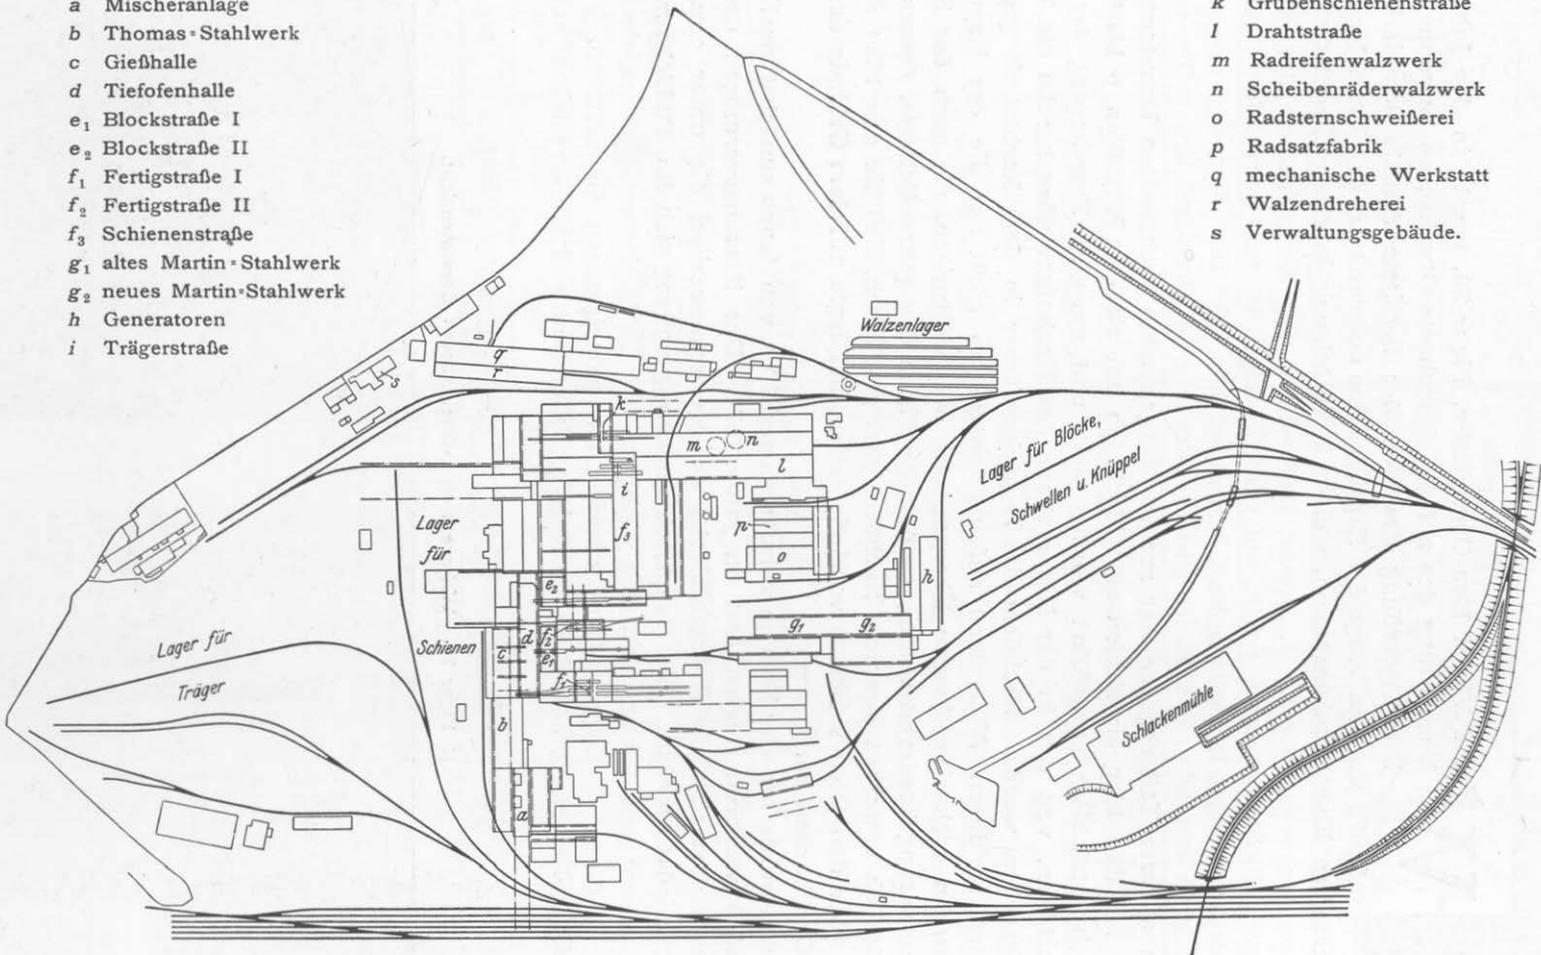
Lageplan des Walzwerkes Neu-Oberhausen.
